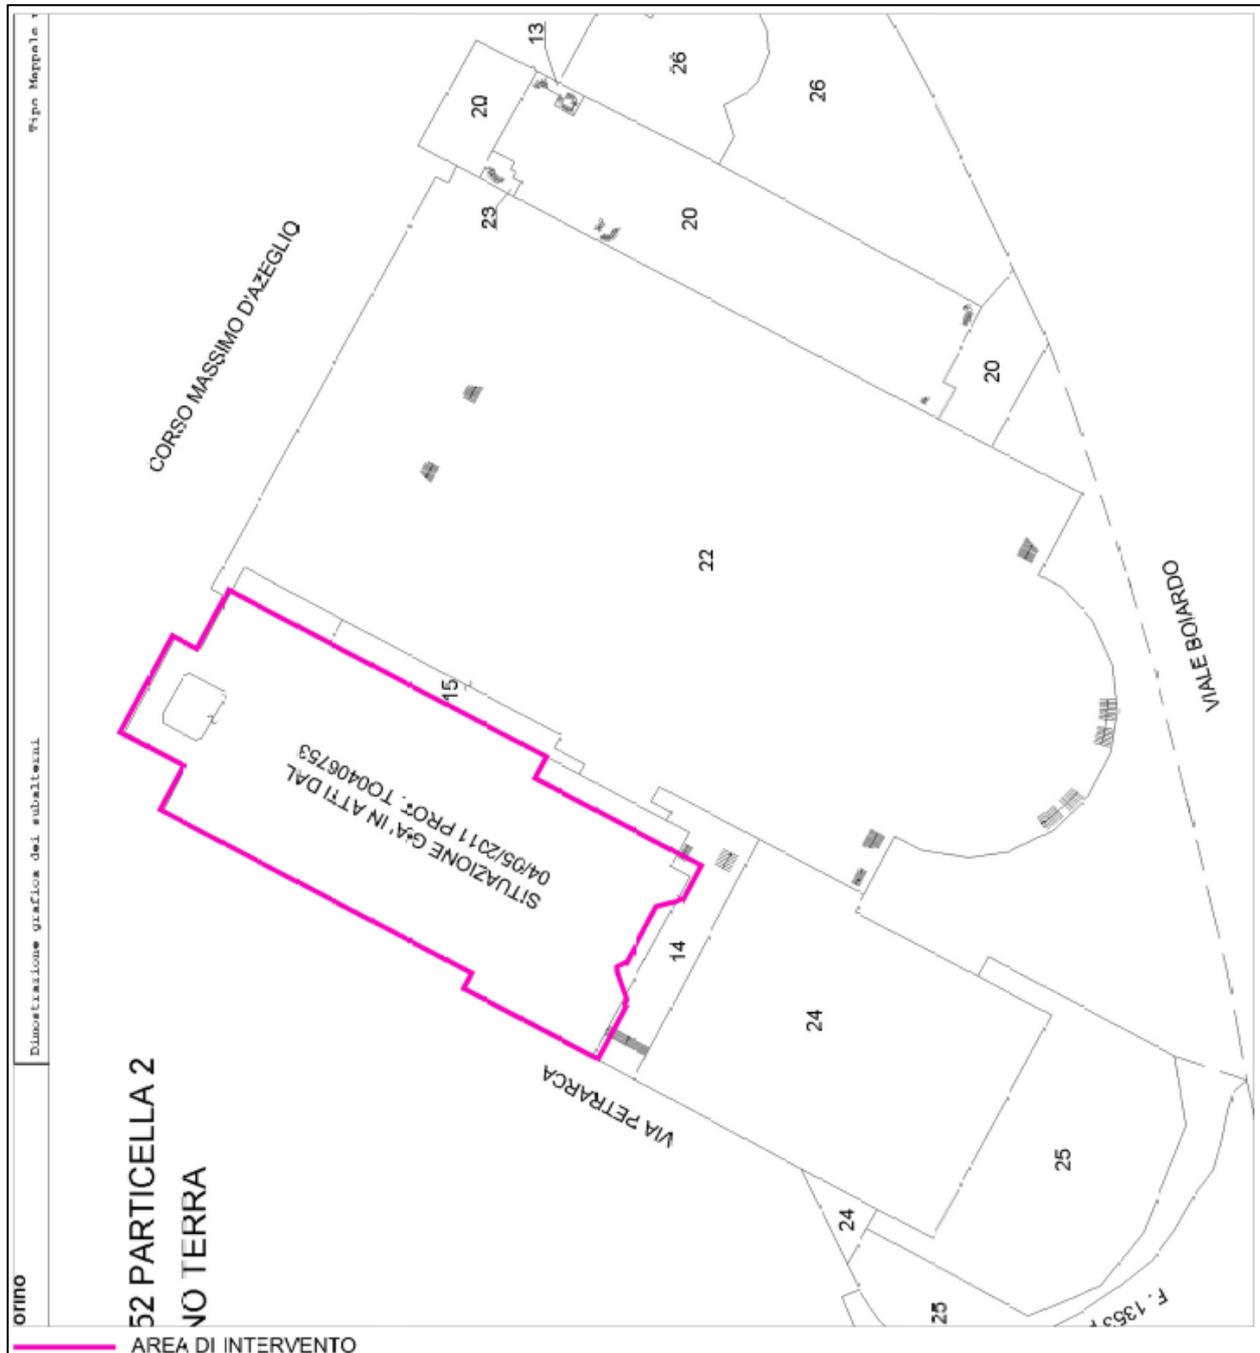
Estratto planimetrico Catastale Comune di Torino. F. 1352, part. 2
